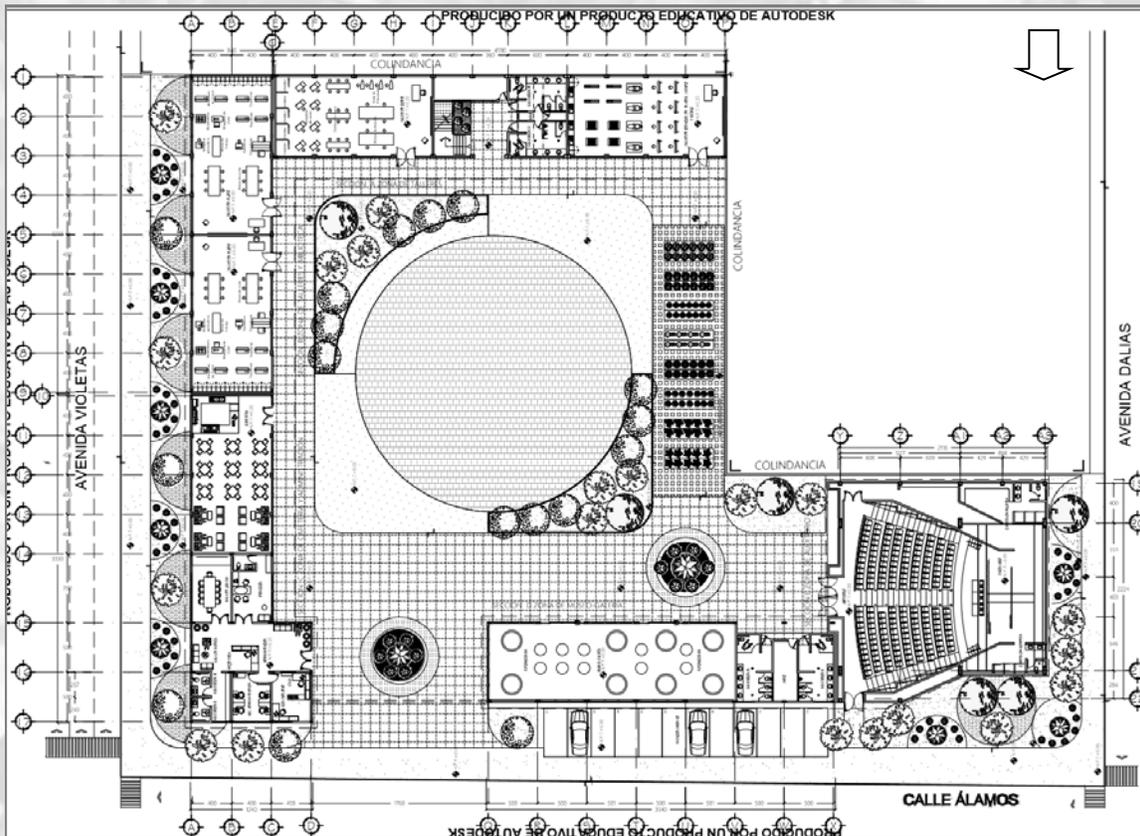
Conjunto Planta Baja. Proyecto: Escuela de Diseño Textil “Binni Lula”
